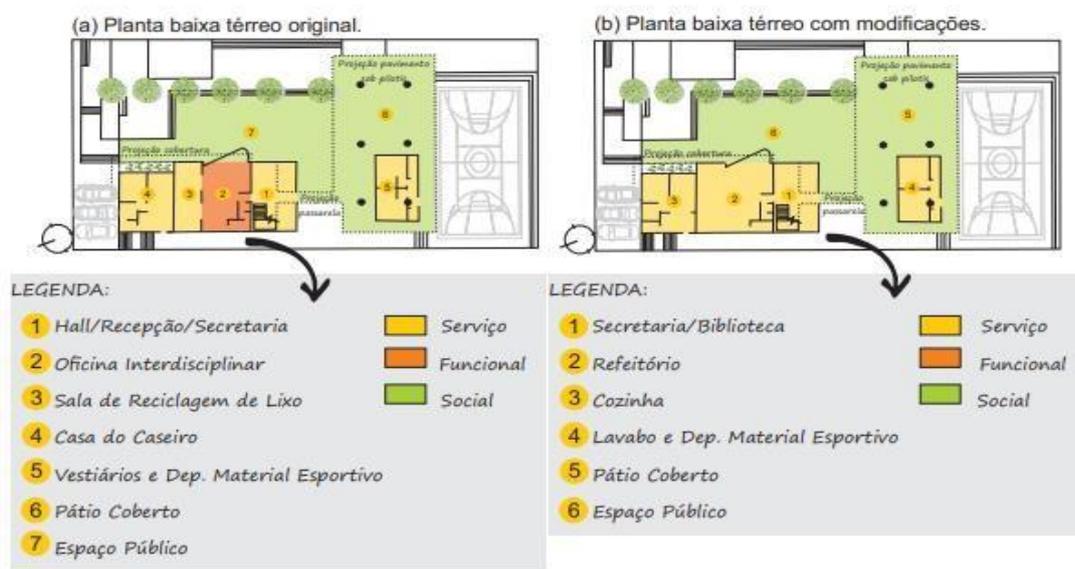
Visualização das áreas. (A - Planta baixa térreo original. B – Planta baixa térreo com modificações).
